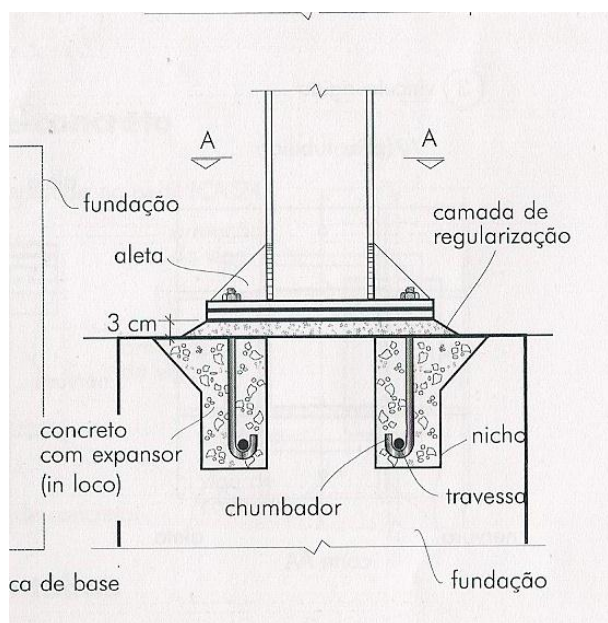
Detalhe da ligação do pilar metálico e sua respectiva fundação de concreto. Fonte: YOPANAN, 2007.
